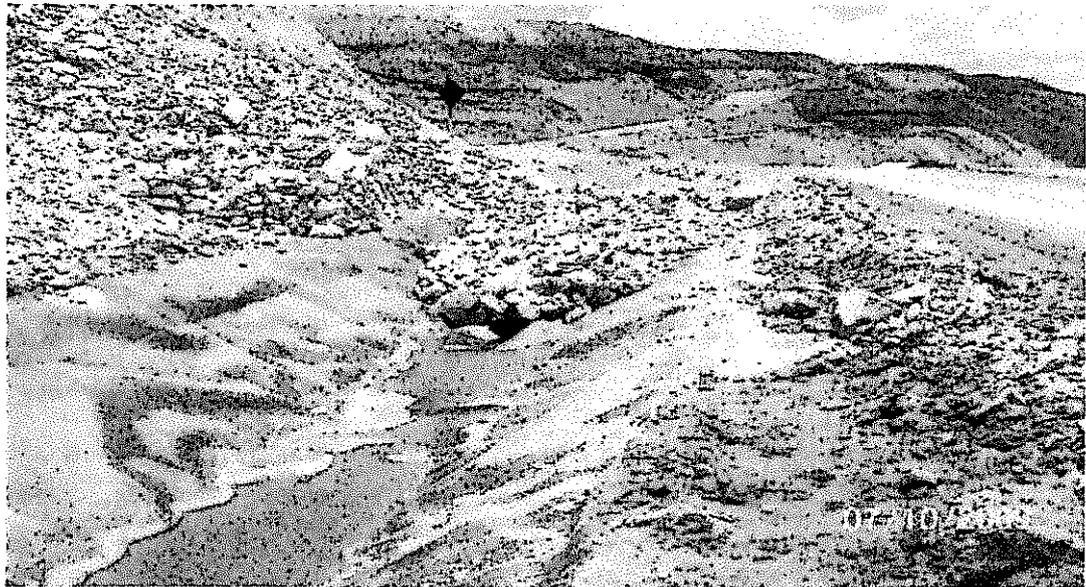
Observación 3 (Supervisión 2009): Tramo de canal Intermedio Tajo Suro Sur obstruido por derrumbe.
